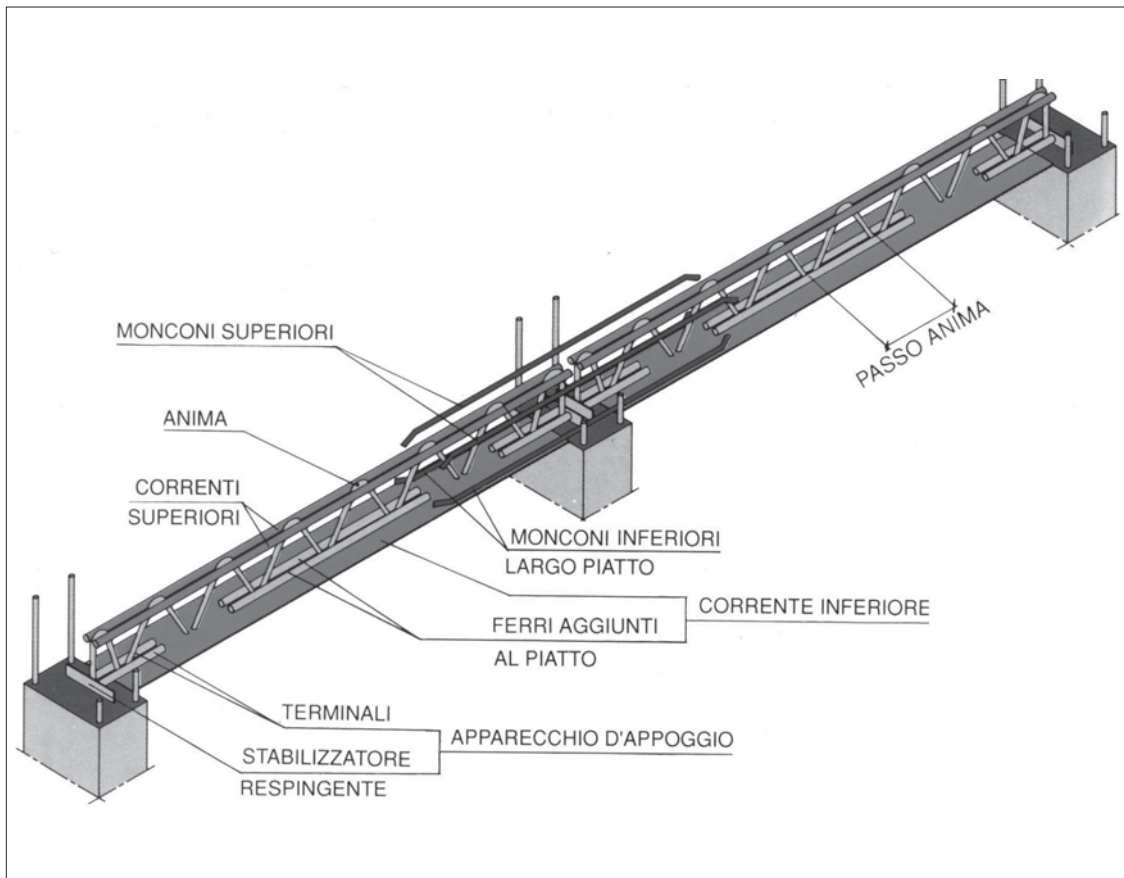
Schema della trave reticolare mista con particolare dei monconi.
